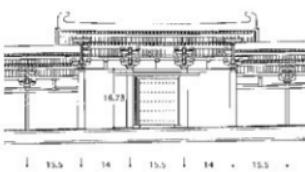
東面回廊軒門桁行断面図 平成14年度案 1:400
